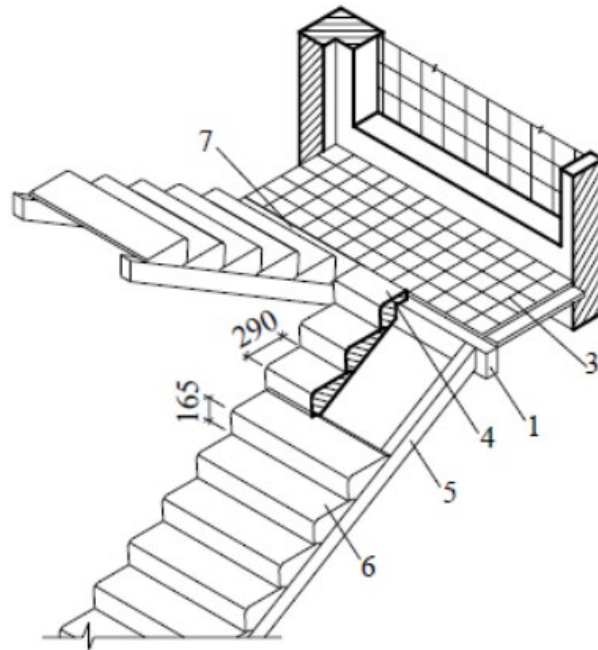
Схема залізобетонних двомаршевих сходів: 1 – підкосоурна балка; 3 – міжповерхова площадка; 4 – верхній фризовий східець; 5 – залізобетонний косоур; 6 – рядовий східець; 7 – нижній фризовий східець.
